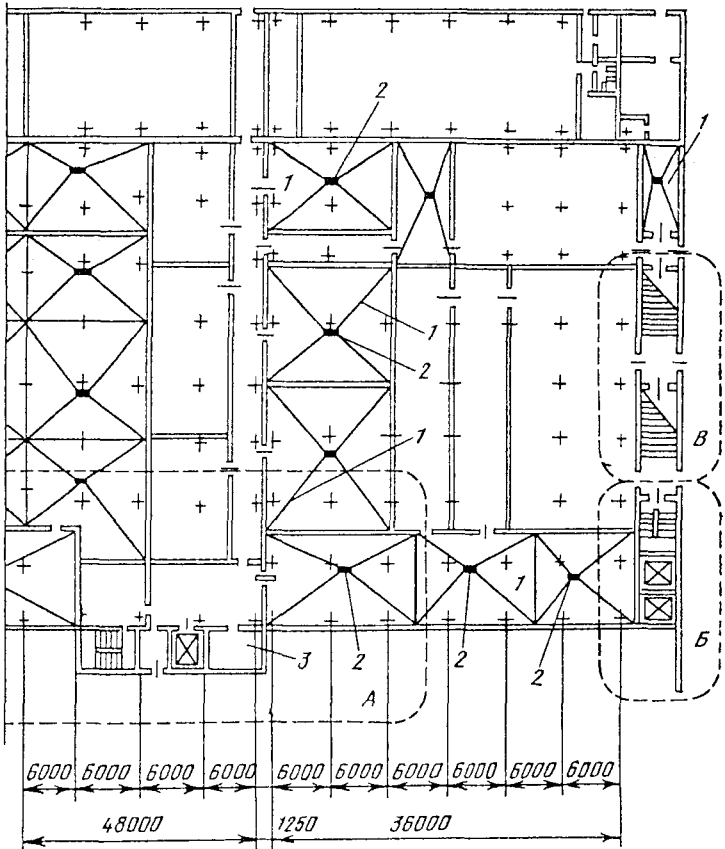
План первого этажа мясоперерабатывающего комбината:
